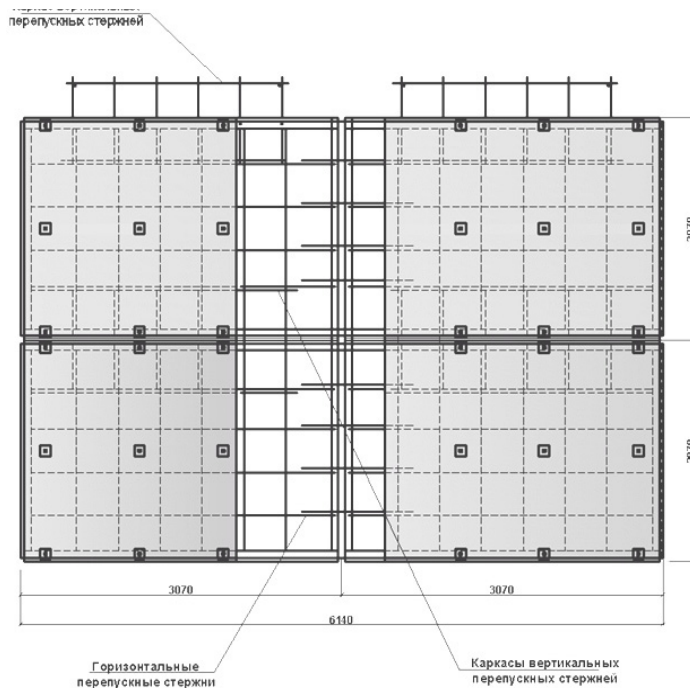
Схема соединения с помощью перепускных стержней четырех армоблоков стены с плоскими рамами
